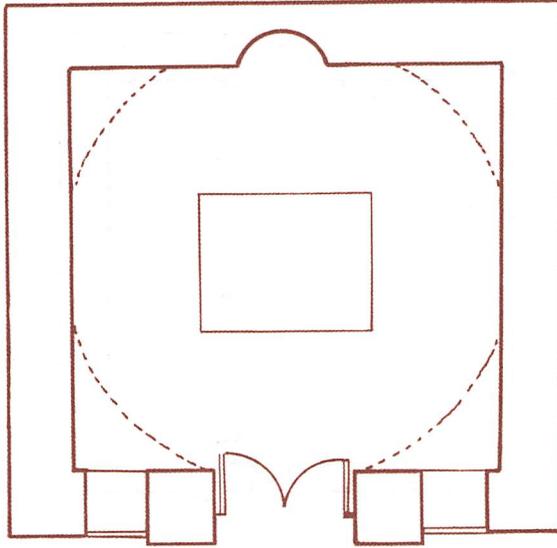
المسقط الأفقى لقبة وضريح العريان بديروط
